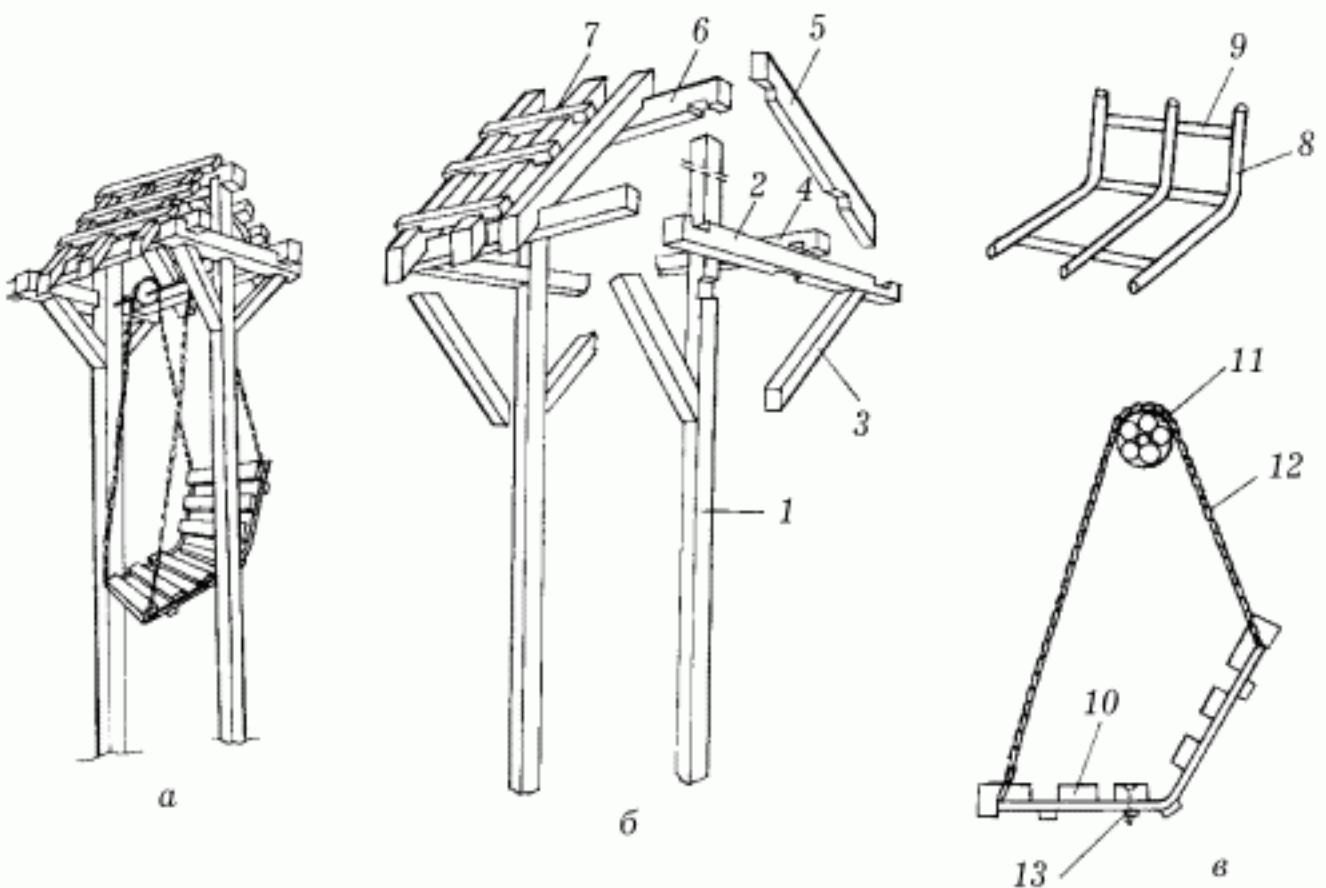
Качели под крышей: а – общий вид; б – схема монтажа деревянной конструкции; в – конструкция сиденья; 1 – стойка; 2 – поперечина; 3 – подкос; 4 – мауэрлат; 5 – стропила; 6 – коньковый брус; 7 – обрешетка; 8 – металлическая трубка; 9 – металлическая полоса; 10 – доски; 11 – шарикоподшипник; 12 – цепь; 13 – болт с гайкой.
